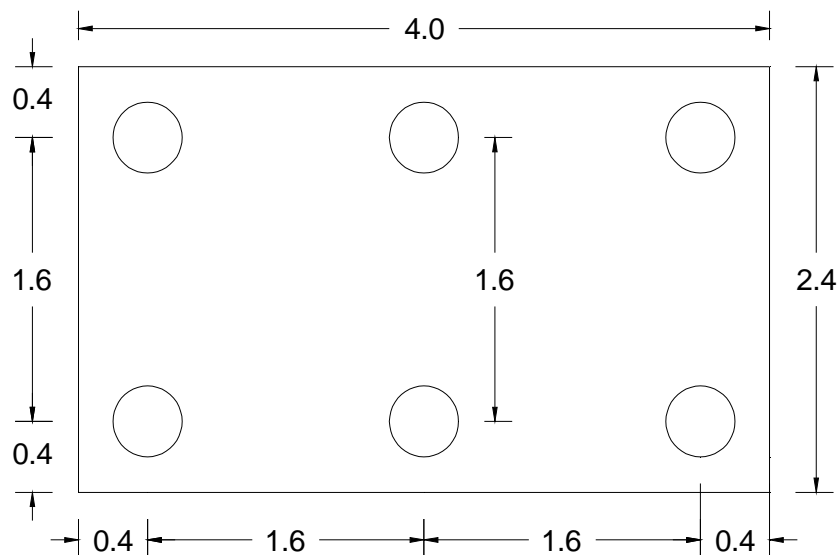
Grupul de piloți. Vedere în plan. Distanța interax 1,6 m
